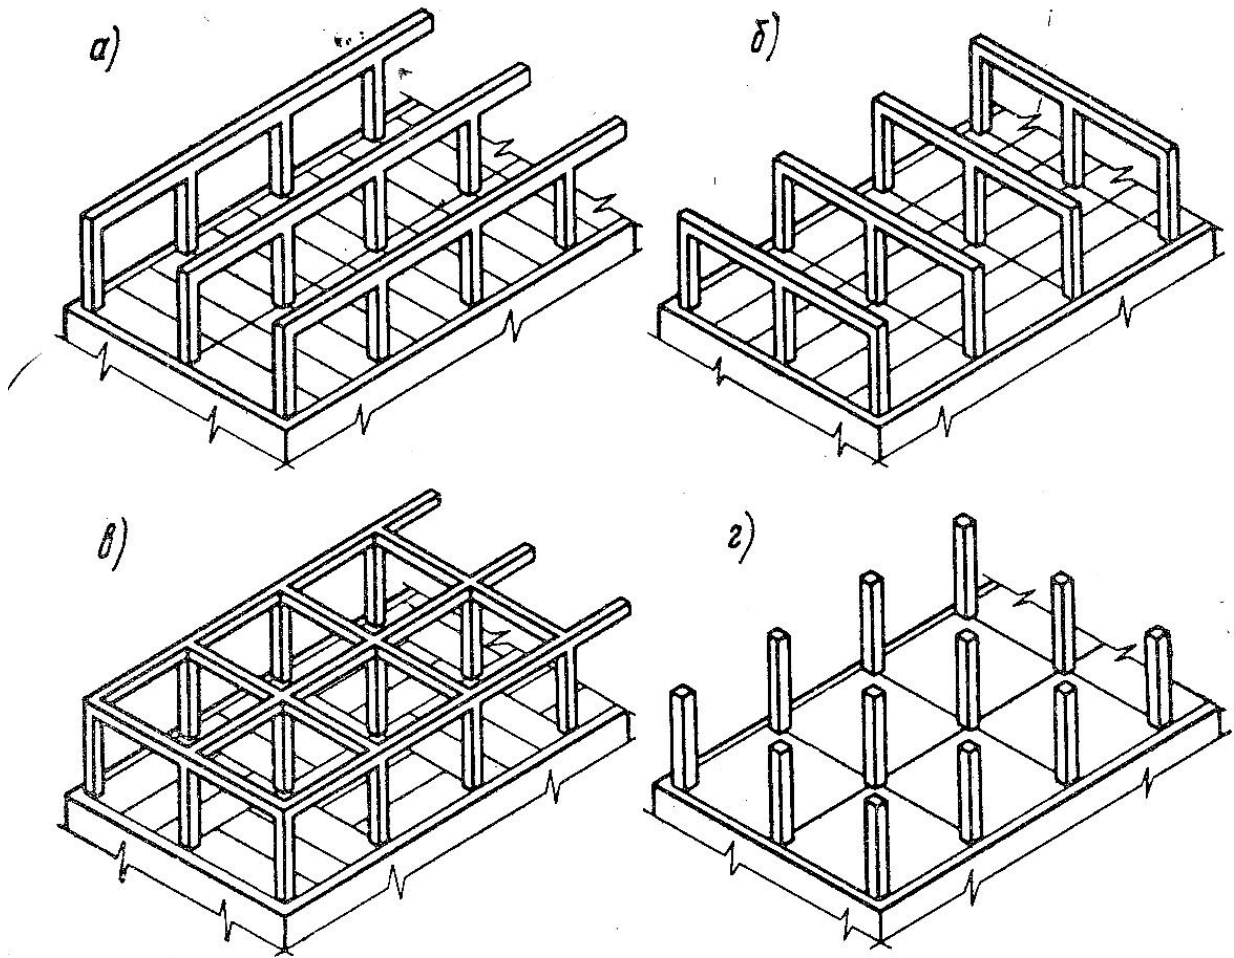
Конструктивні системи каркасних будівель: а) з поздовжнім розташуванням ригелів; б) з поперечним розташуванням ригелів; в) з перехресним розташуванням ригелів; г) безригельний [13]
